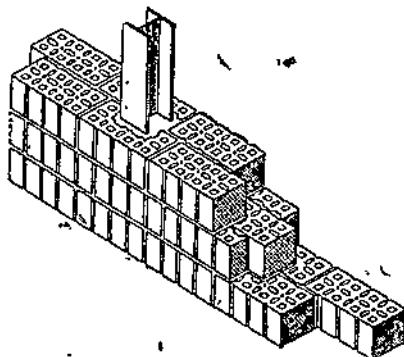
Кладка стены из блоков с поперечными отверстиями.
